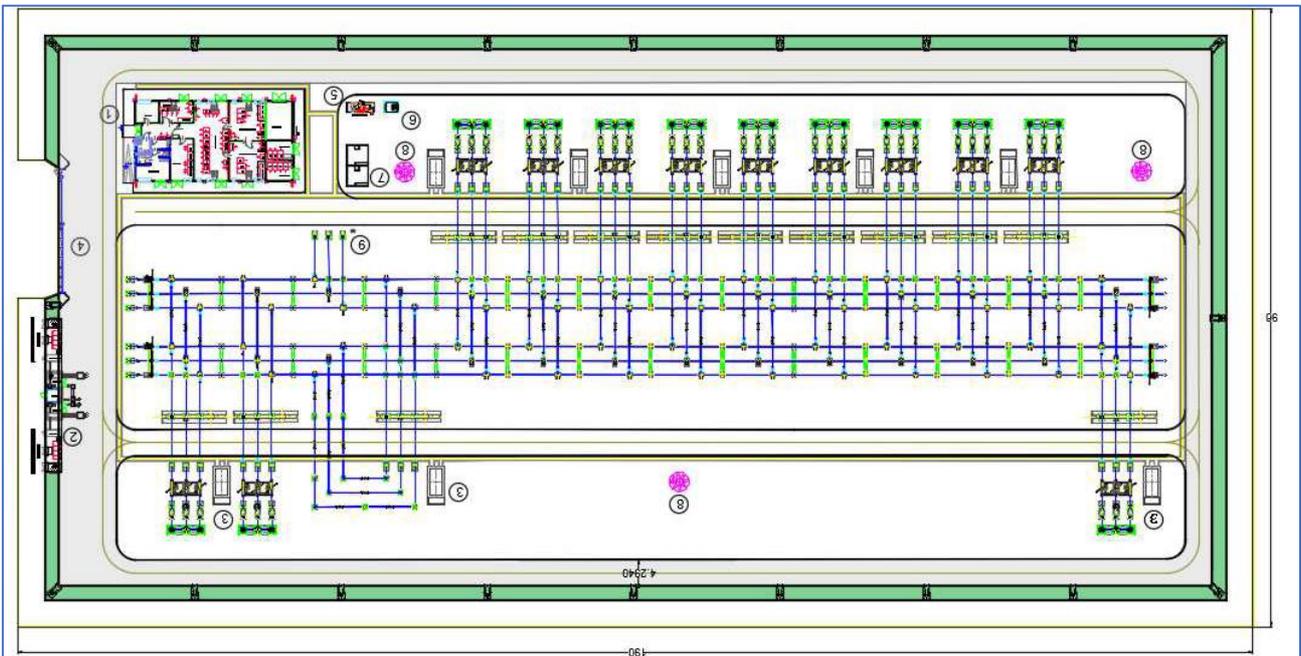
Planimetria elettromeccanica della Stazione "satellite" Terna Genzano
